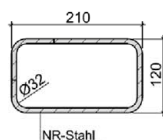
Geschlossener Bügel 1 × Ø 8 mm
